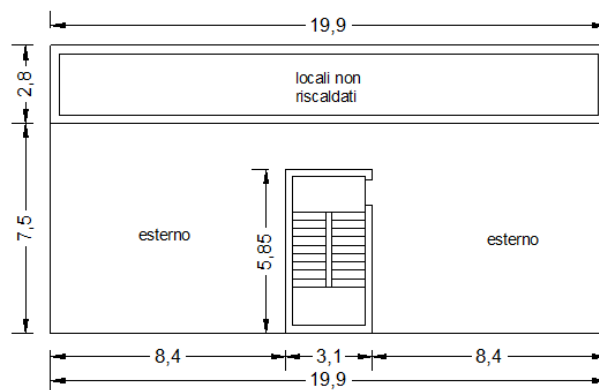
Planimetrie Edificio Tipo 1.3
